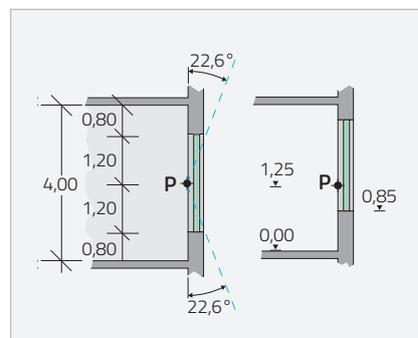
Lage des Nachweisortes P in Grundriss (links) und Schnitt (rechts) nach DIN EN 17037
